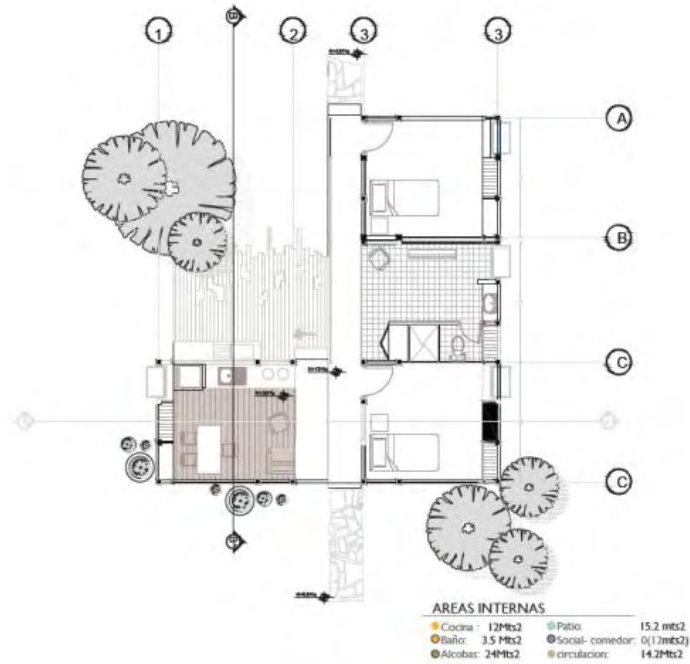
Planta I piso, Segunda etapa vivienda BI Fuente: propia
